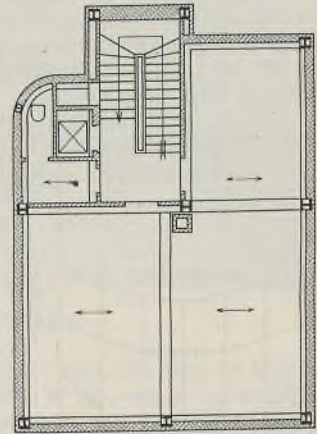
Grundriß mit Angabe der Stützenstellung und der Spannrichtung der Eisenbetondecken.
